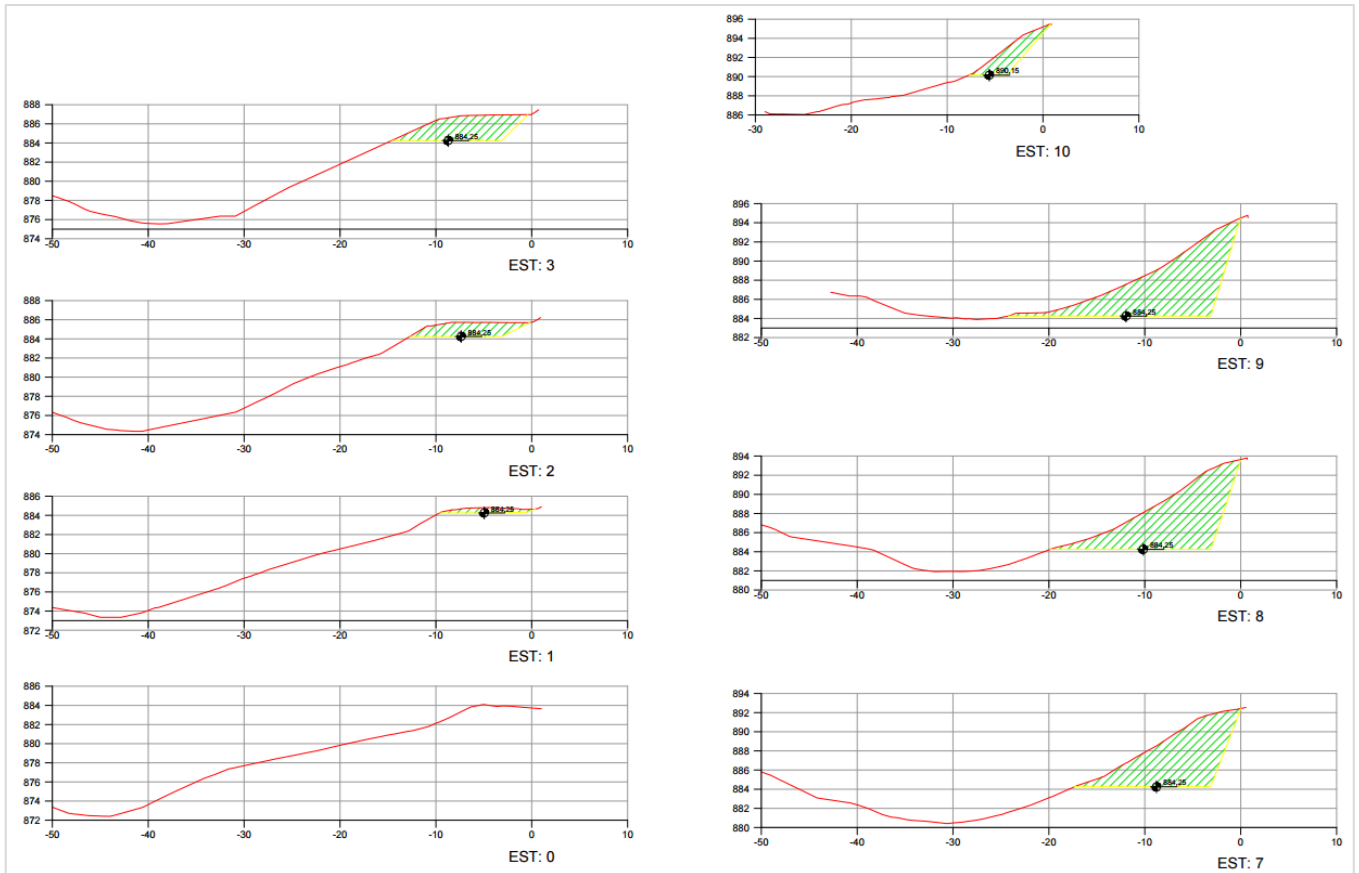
Seções do projeto de terraplenagem (Fonte: arquivo "Azimute_-_Projeto_T.pdf").
